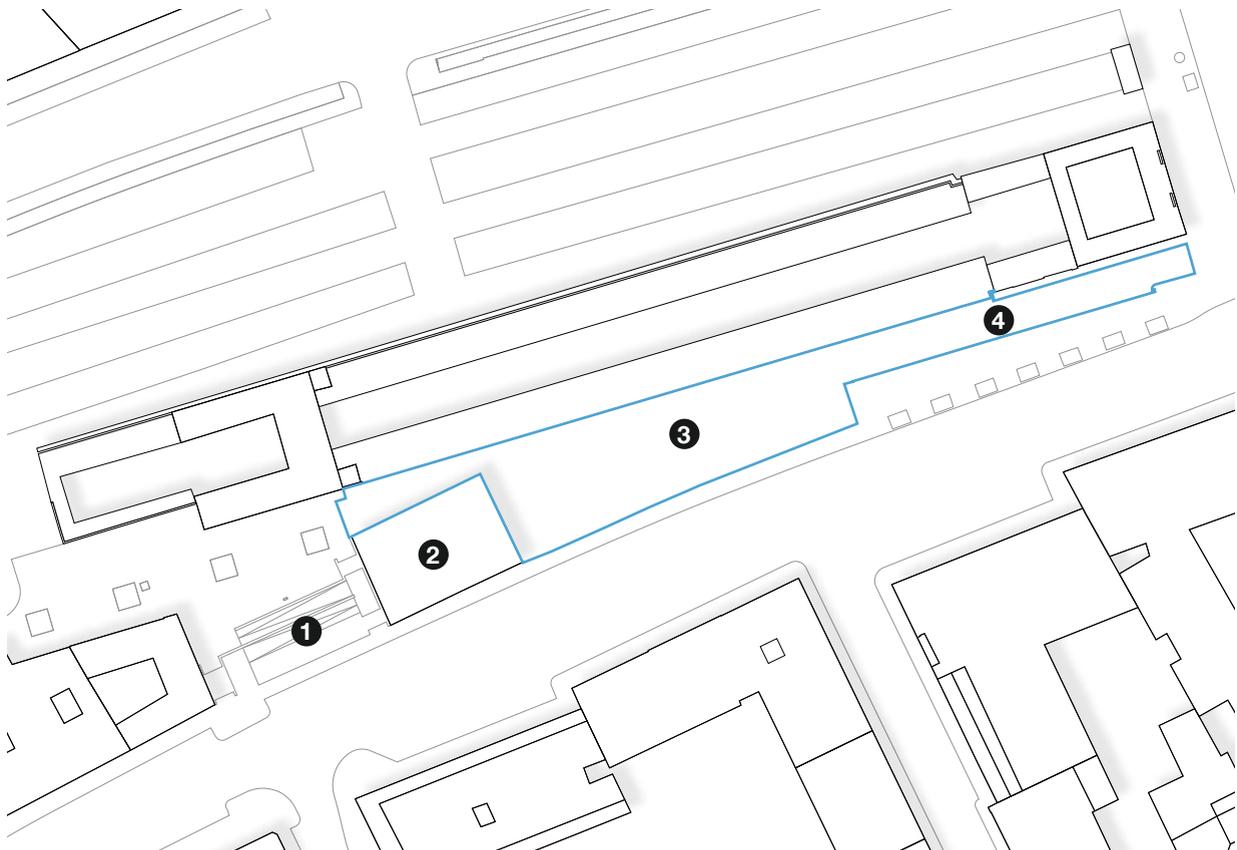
; Otto Wagner Plan zur Errichtung der Stadtbahn mit Bestandsgebäuden, Wiener Linien, maßstabslos
